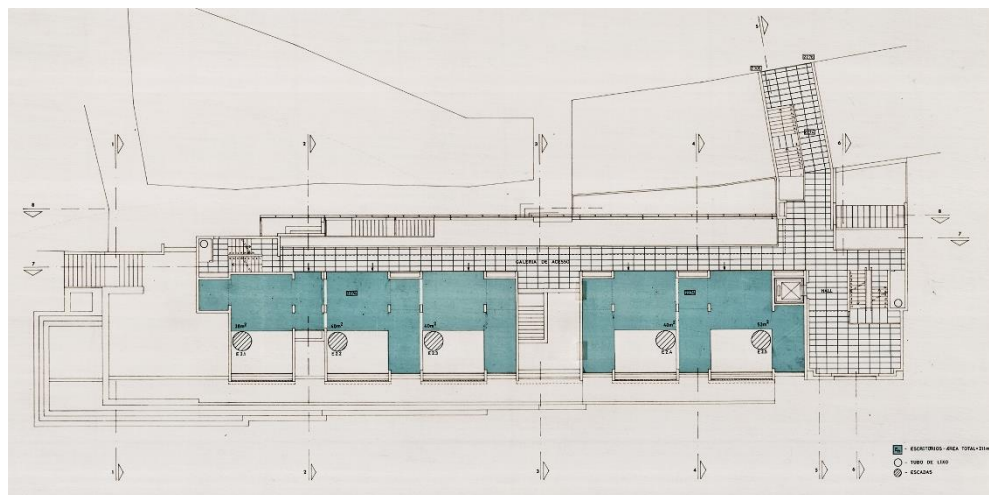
Planta do Piso 3, Projeto Geral – 1ª Fase, Rua do Marquês de Alegrete - EPUL, fevereiro de 1974.
